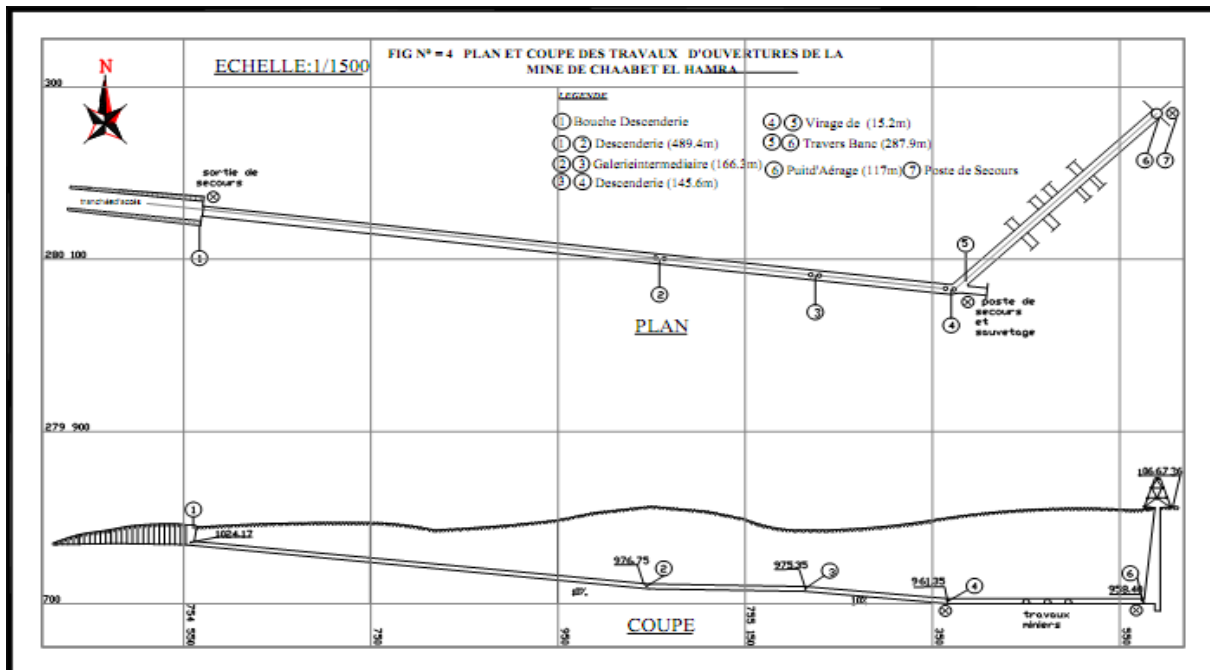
Plan et coupe des travaux d'ouvertures de la mine de Chaâbet El-Hamra. [34]
